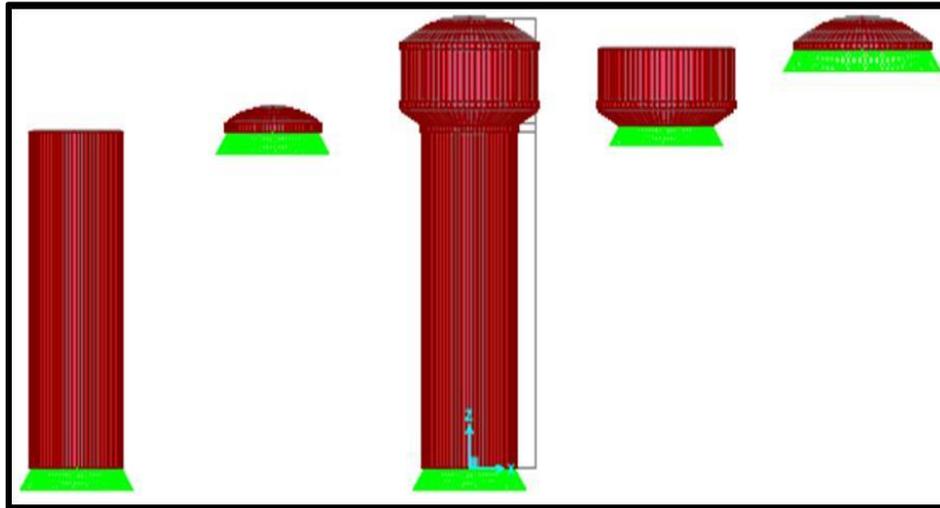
Modelamiento por separado de elementos estructurales del Reservorio de Tanque elevado
